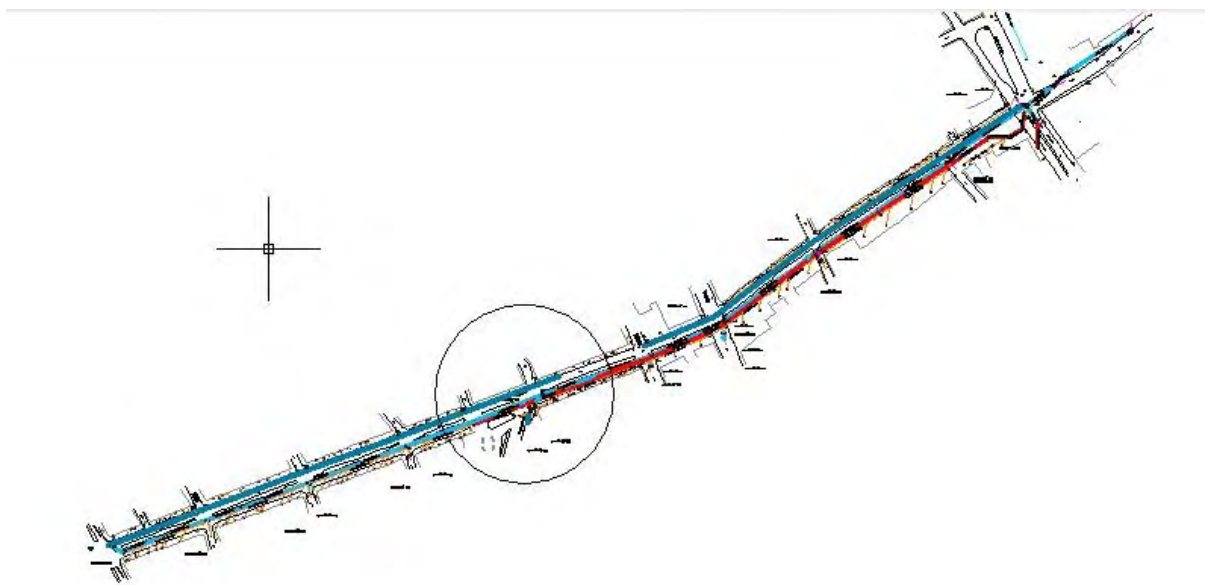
, Plano definitivo sistema de alcantarillado Avenida Las Américas entre calle 22 y calle 12.
